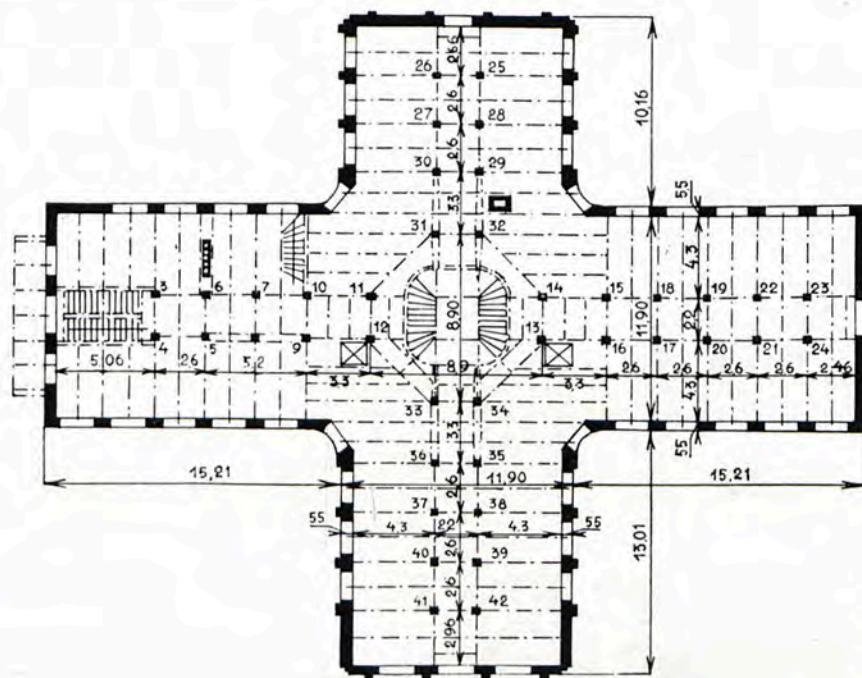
Plan du bâtiment et disposition des colonnes, poutres longitudinales et solives de l'ossature métallique.
